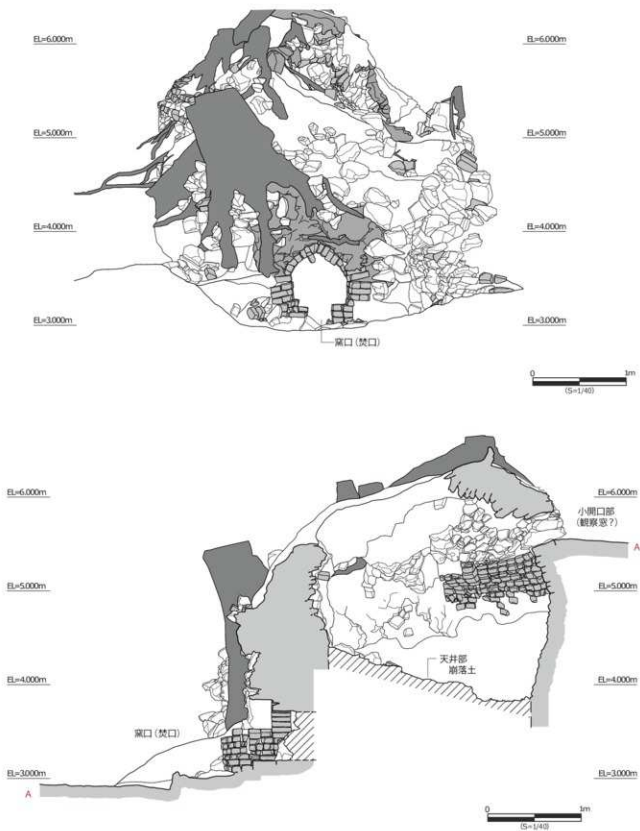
福花の石灰窯跡 1号窯 (立面図・断面図)
